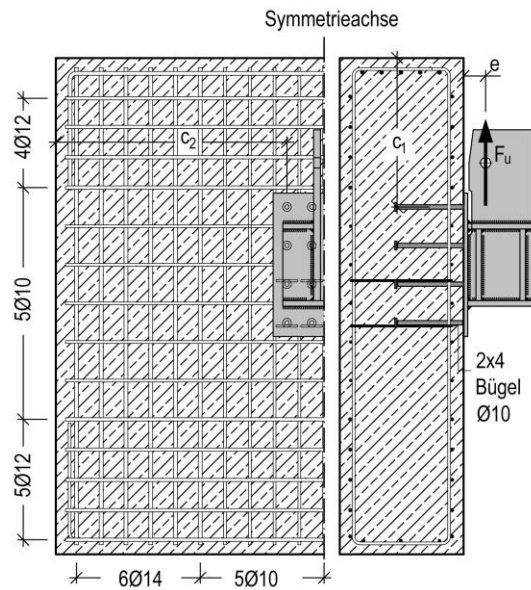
Schematischer Bewehrungsplan des Versuchskörpers R5-3Q
